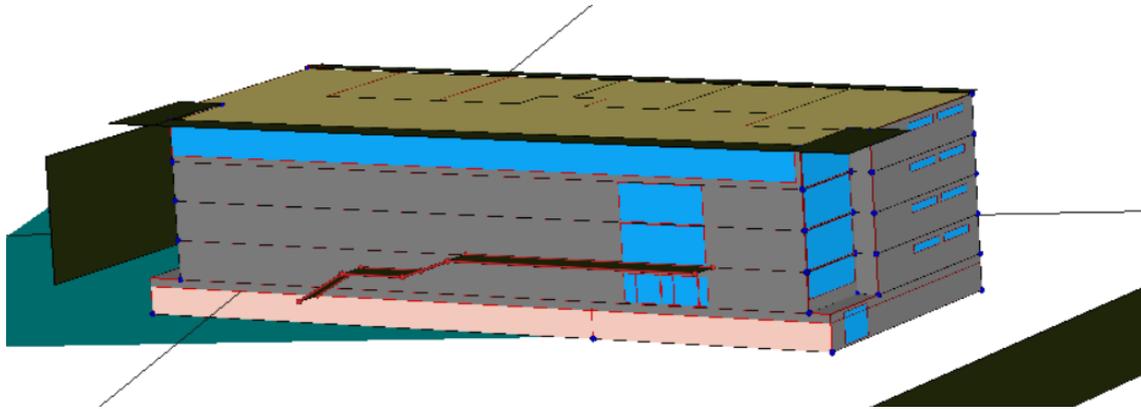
Modelización del edificio en HULC. Fachadas este y sur.
